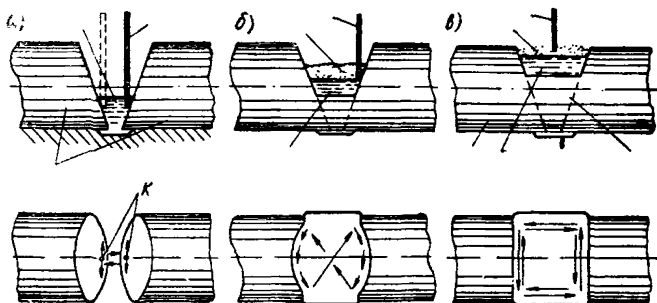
Техника полуавтоматической ванны дуговой сварки стыковых соединений горизонтальных стержней
